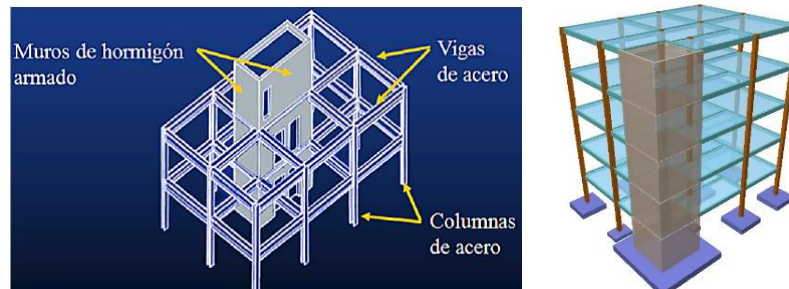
Pórtico de Acero Laminado con Muros Estructurales de Hormigón Armado (S4).
